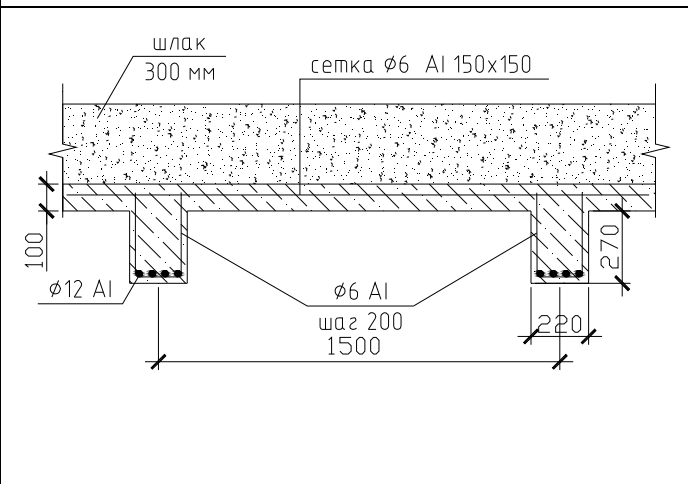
Второстепенная балка ж/б перекрытия над пятым этажом в осях «3-7/ В-Е»
